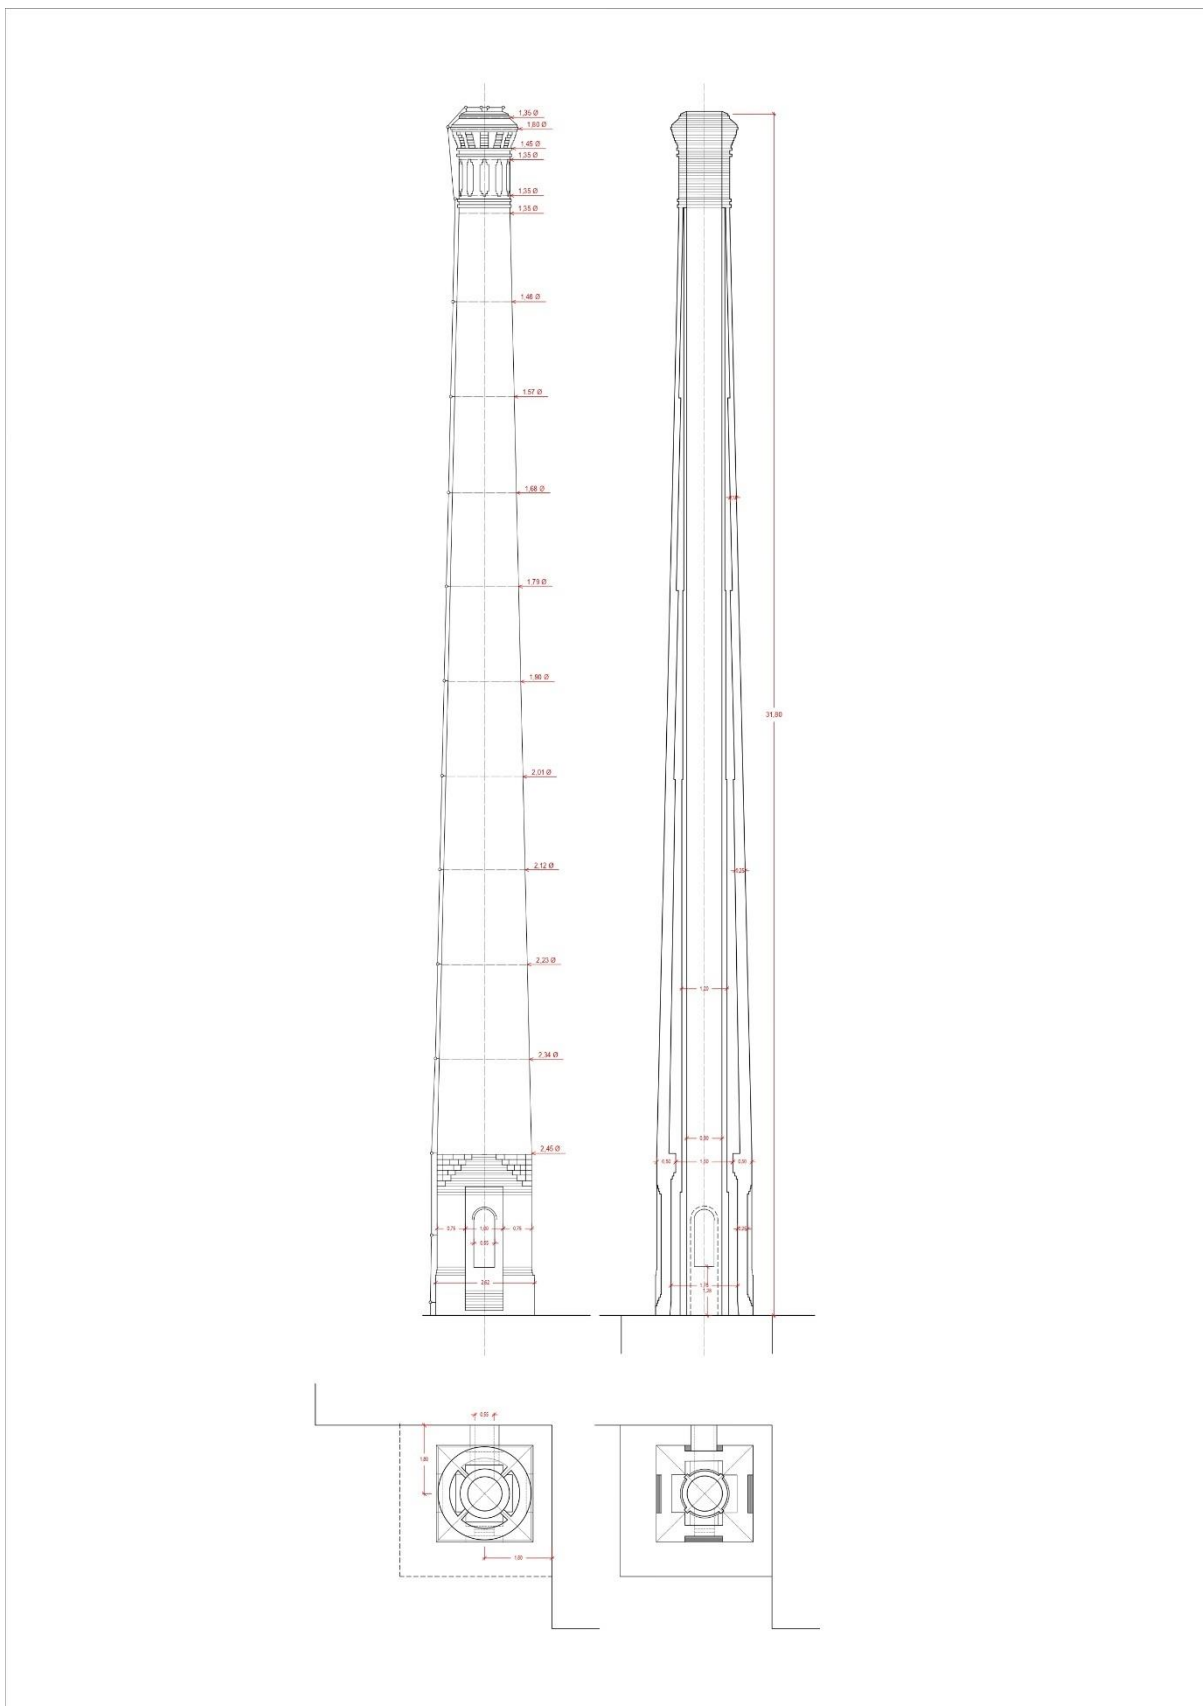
Chimenea. Alzado, sección y secciones de planta (1:50)
